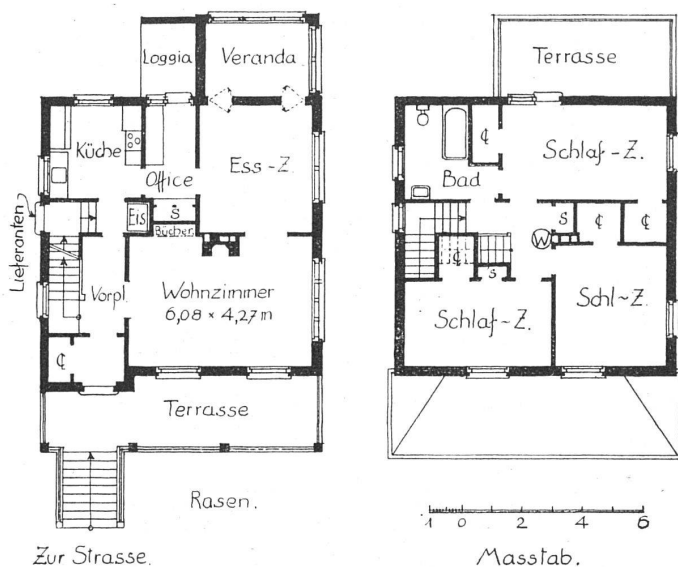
Grundrisse eines typischen Einfamilienhauses. Terrasse (sog. »Porch«) fast immer gegen die Strasse. Dagegen wird die Veranda (sog. »Sun-Room«) nach der Südlage orientiert. Zwischen Vorplatz und Wohnzimmer offener Durchgang. Beim Lieferanteneingang der Eisschrank, Putzloggia. Bei W im Obergeschoss der Wäscheschacht (»Laundry-Shut«). Im Dachgeschoss drei Zimmer und Bad. Kosten des Hauses mit Land 30—40000 Franken.
